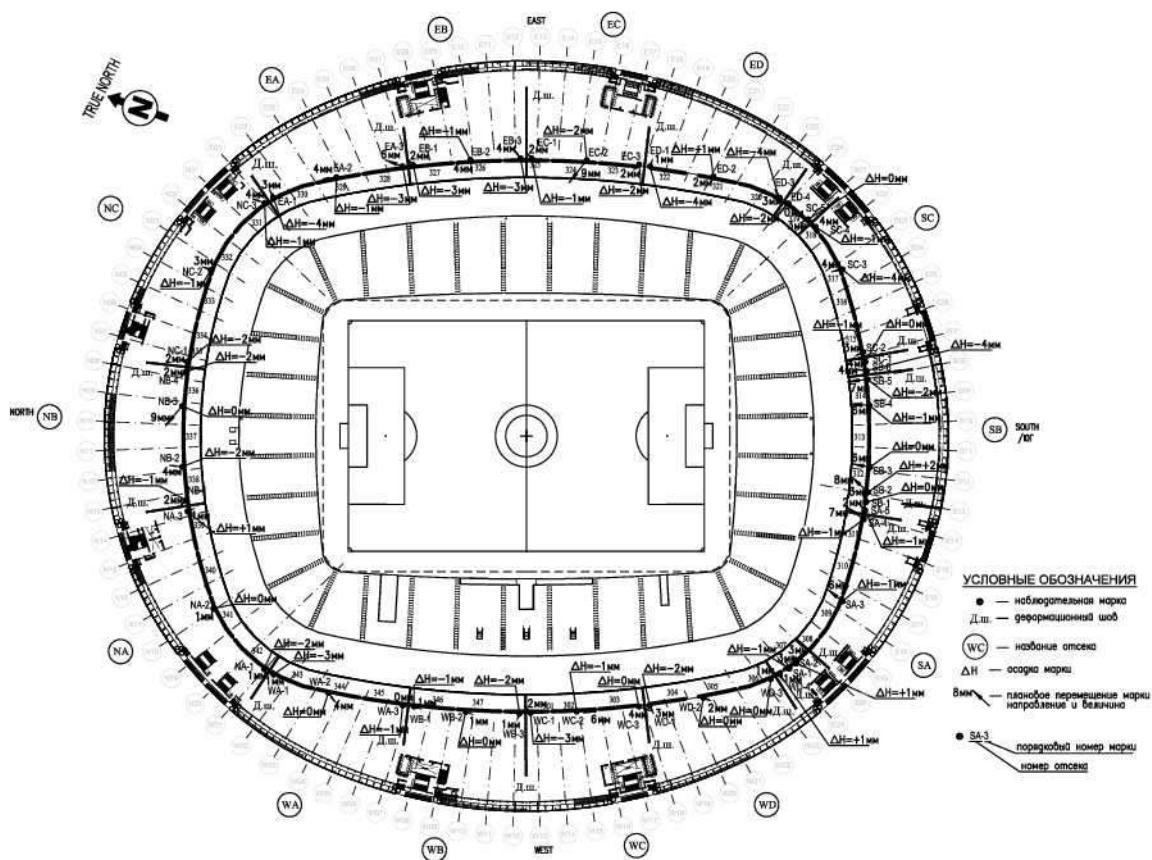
Схема перемещений наблюдательных марок на парапетных стенах (7 уровень)
